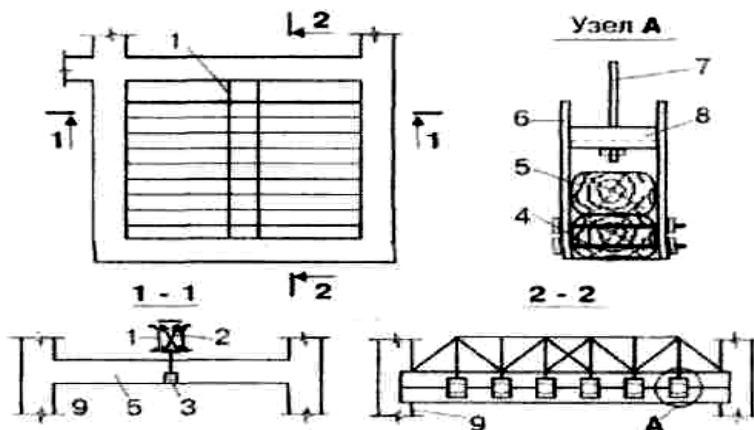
Підсилення дерев'яних балок зміною їх конструктивної схеми: 1 - металева ферма; 2 - хрестова в'язь; 3 - елемент підвіски балки (вузол А); 4 - стягуючі болти; 5 - балка, що підсилюється; 6 - металевий тяж; 7 - металеві накладки; 8- швелер; 9 - існуючі стіни
